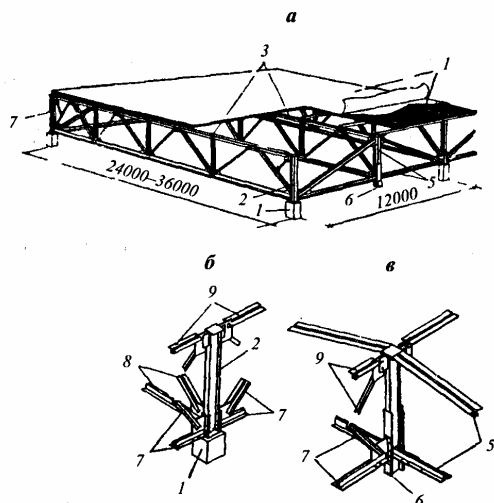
Сопряжение стальных стропильных и подстропильных ферм:
